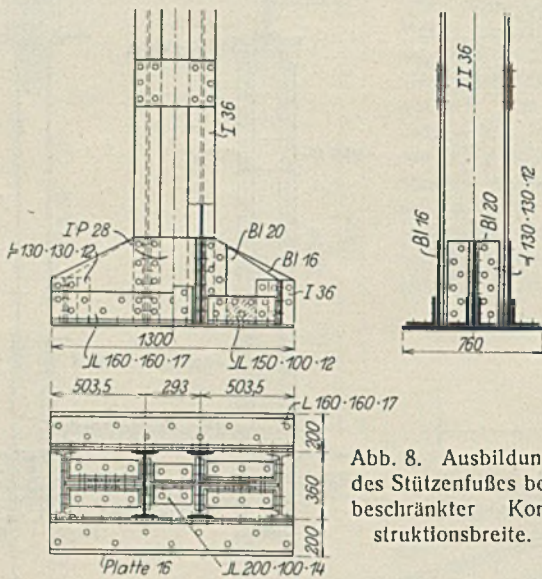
Ausbildung des Stützenfußes bei beschränkter Konstruktionsbreite.
